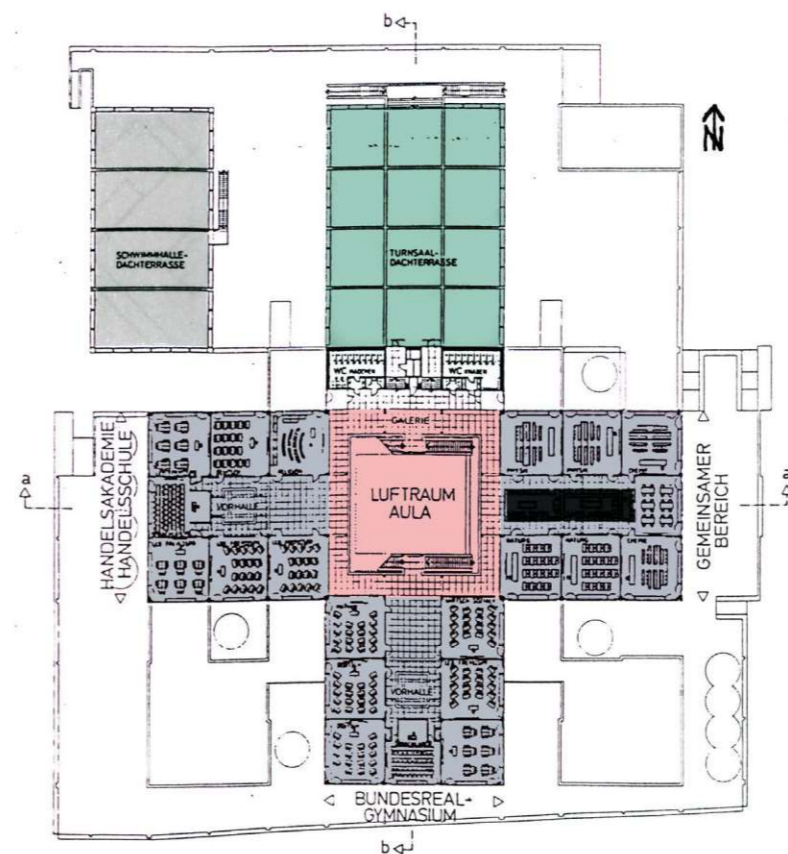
Modellschule Wörgl - Grundriss
